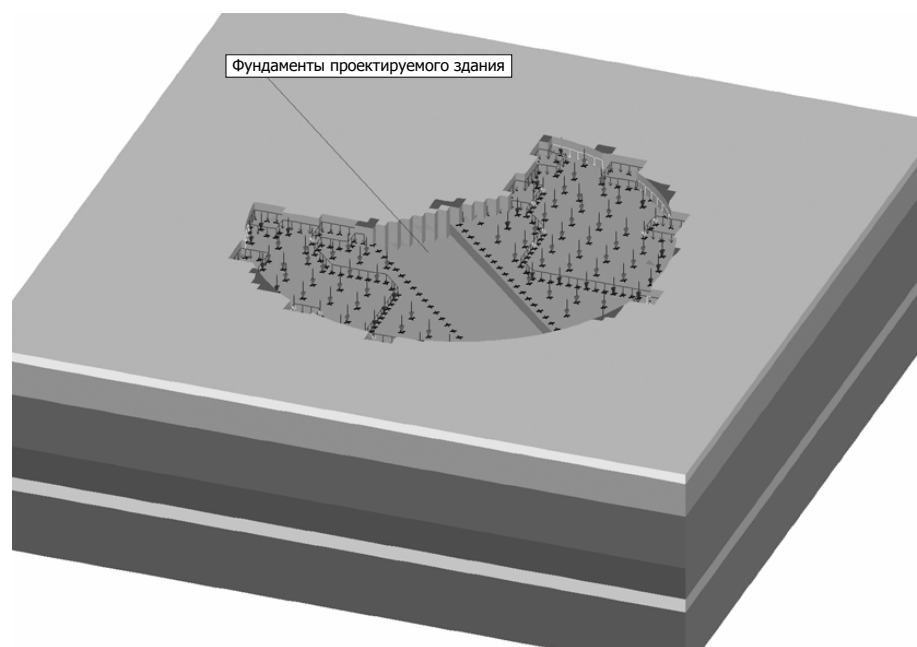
Расчетная схема – устройство здания торгового комплекса на свайных фундаментах у ст. метро «Озерки»
